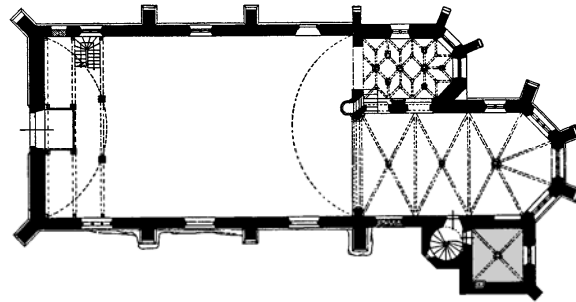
Grundriss der Pfarrkirche St. Franz von Assisi zu Enkirch (aus: VOGTS [1938], S. 136)
